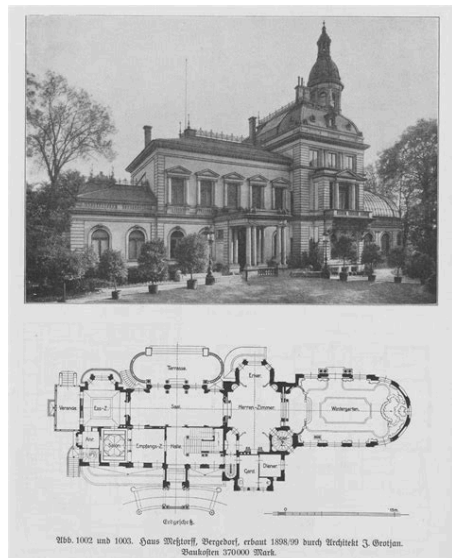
Ansicht der Messtorff'schen Villa mit Grundriss.
